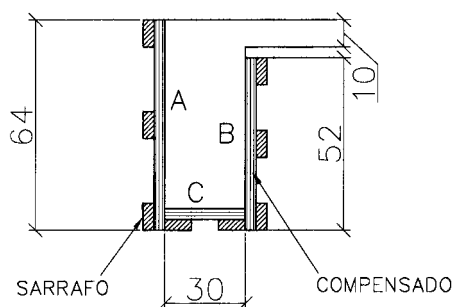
Seção da viga (medidas em cm).
